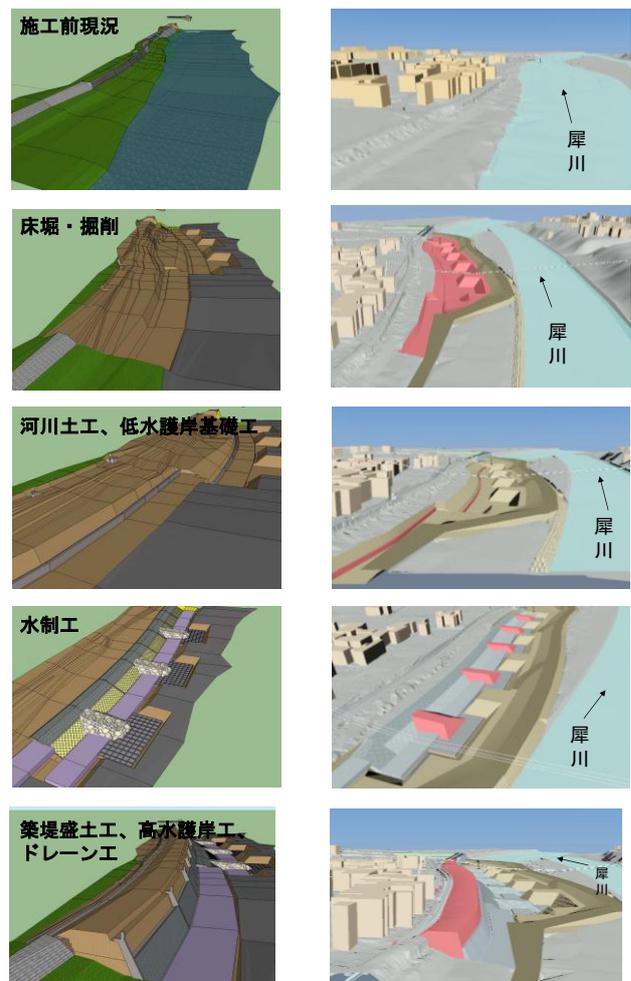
4次元施工ステップモデル（左：施工者作成，右：CIM支援業務受注者作成）
